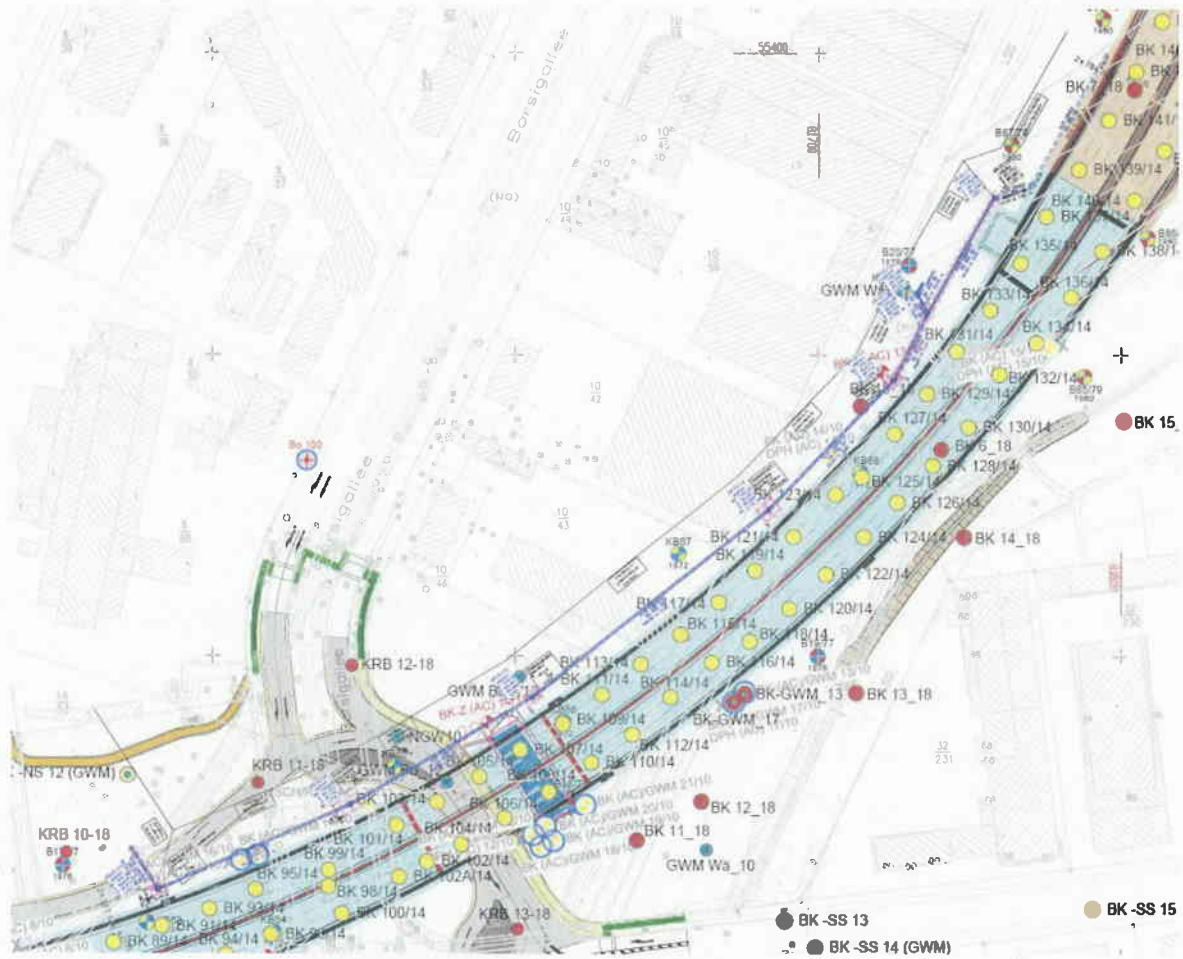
Lageplan Sammelleitung (ELE 11.4.2019)
